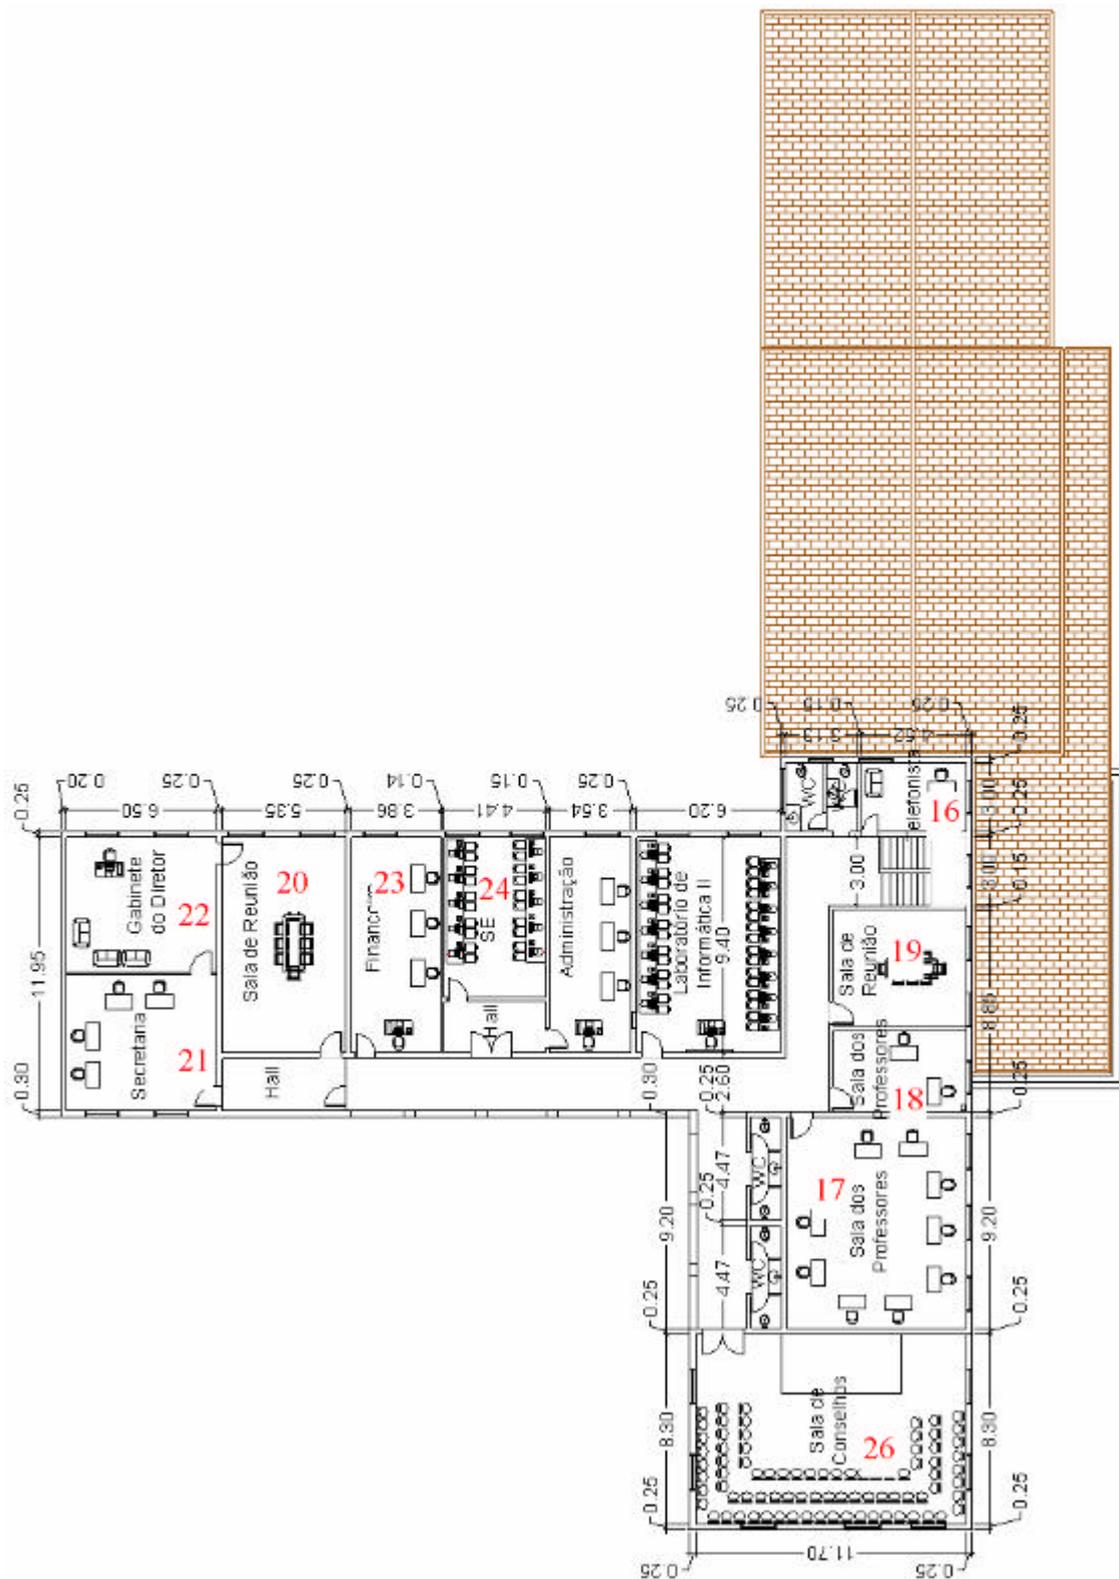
Planta baixa do primeiro pavimento do bloco central
